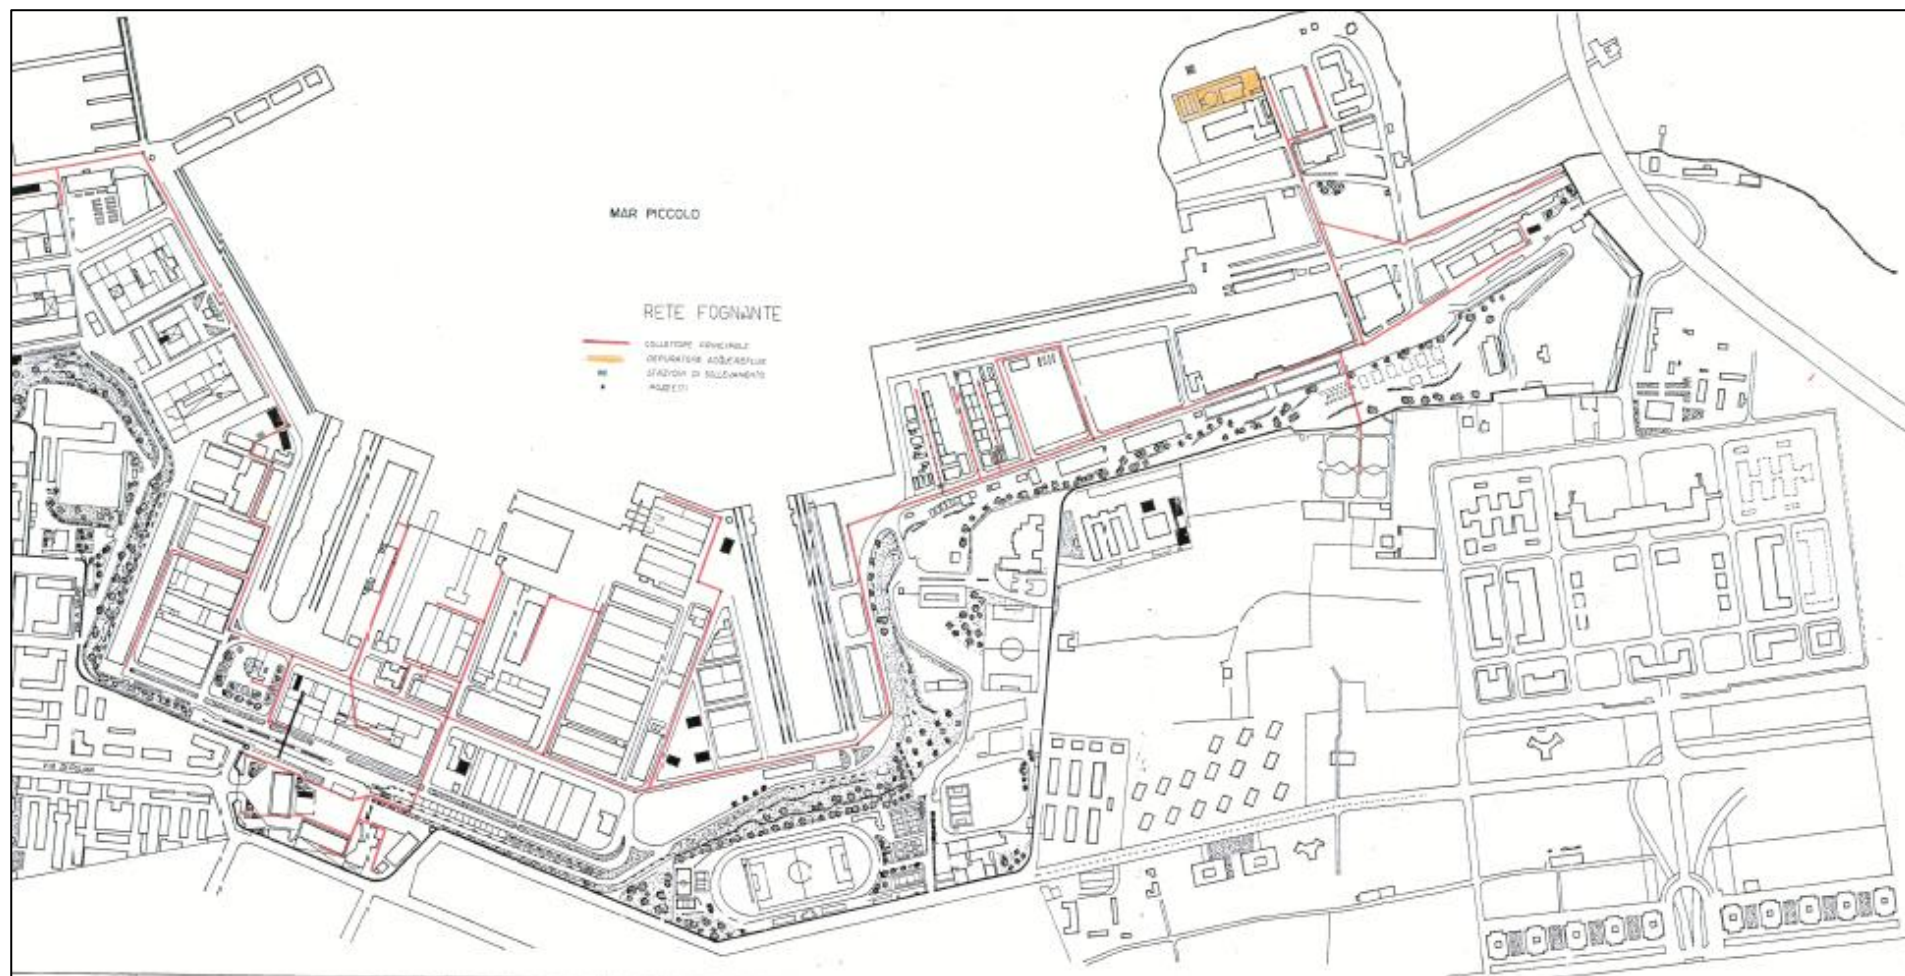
Planimetria sottoservizi fognanti – acque bianche
